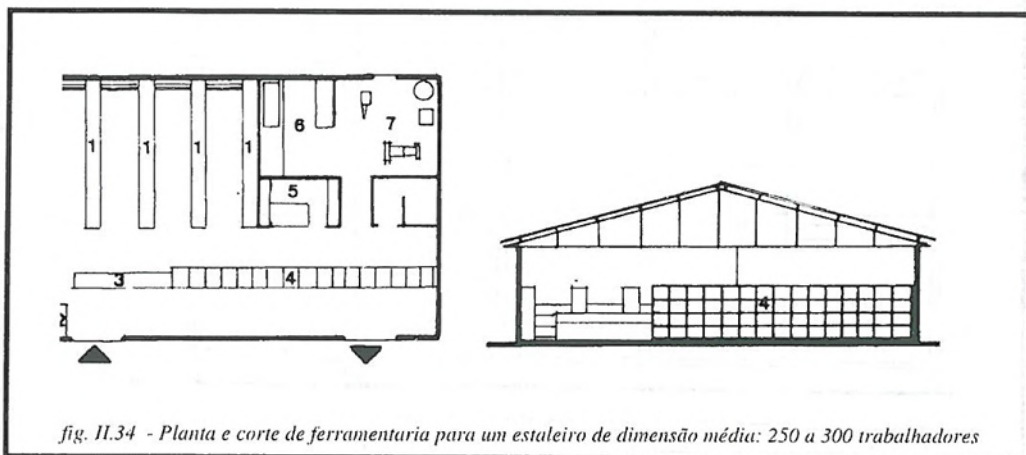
Planta e corte de ferramentaria para um estaleiro de dimensão média: 250 a 300 trabalhadores
